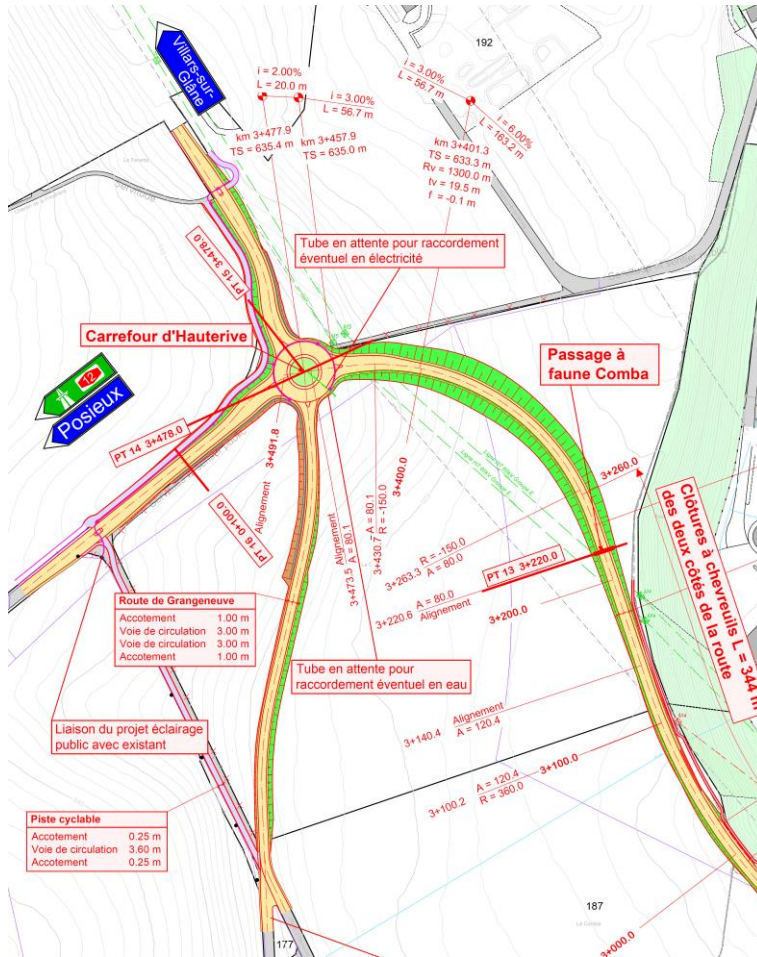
Situation carrefour d'Hauterive – extrait plan EMMA+ (04.12.2020)
